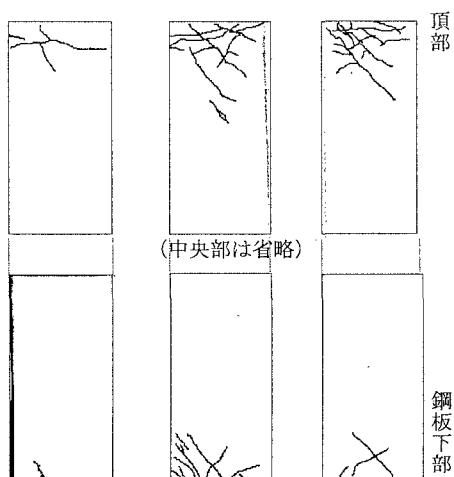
鋼板内部のコンクリートのひび割れ状況
